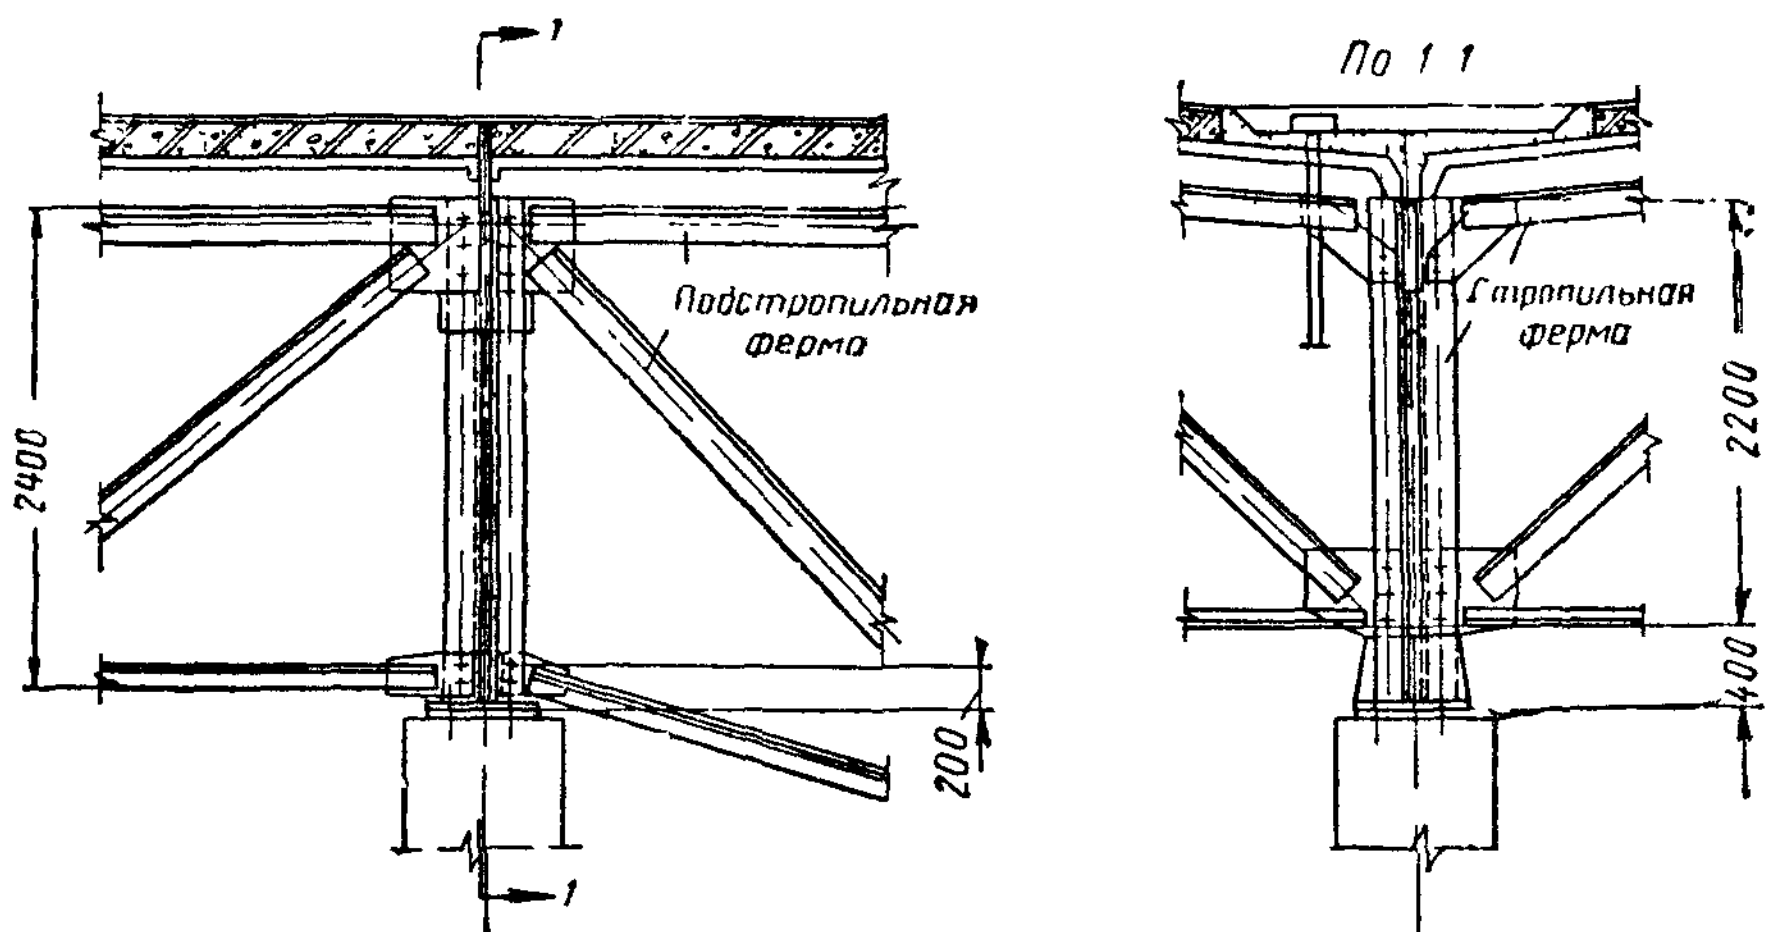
Опираие подстропильных ферм на оголовок колонны сверху
